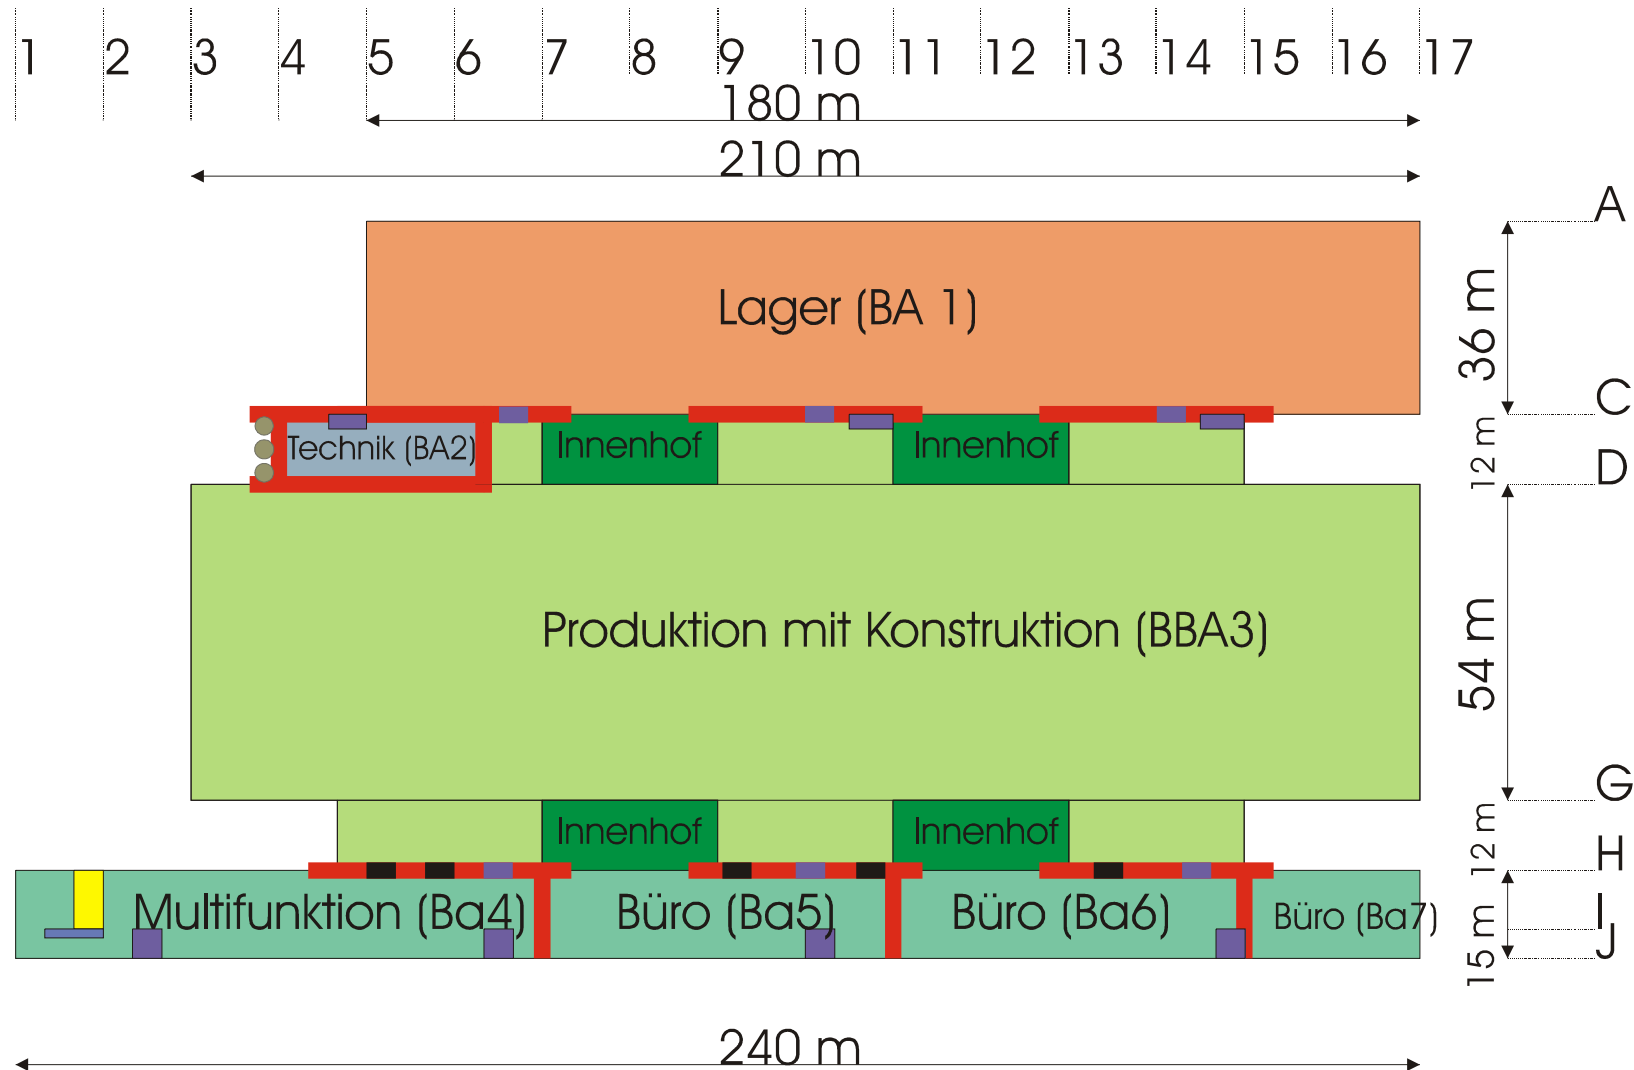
Grundriss des Produktions-, Lager- und Bürogebäudes
